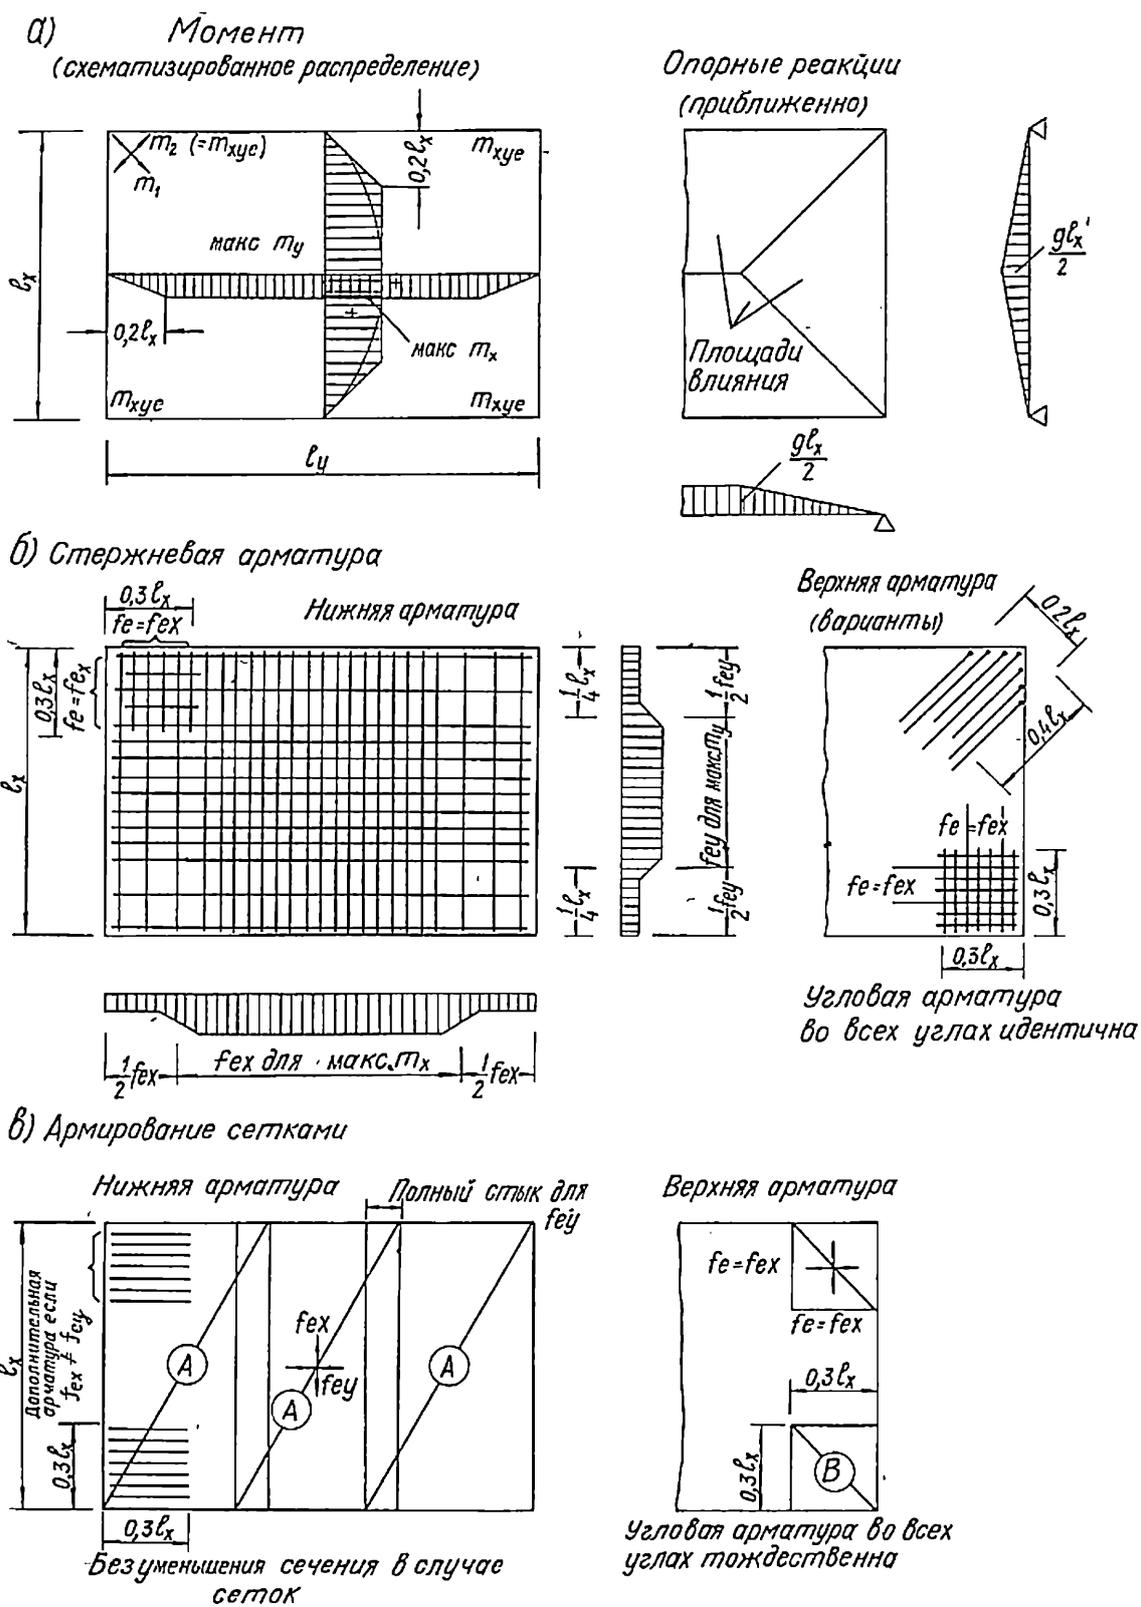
Г - 23. Армирование прямоугольной плиты, свободно опертой по всем сторонам (равномерно распределенная нагрузка)
